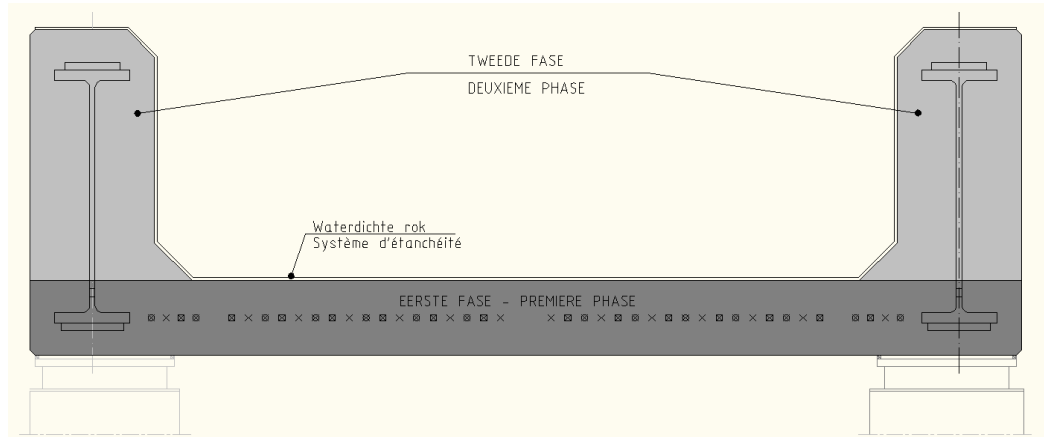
« Ponts en auge » préflex ou pont-bac préflex
